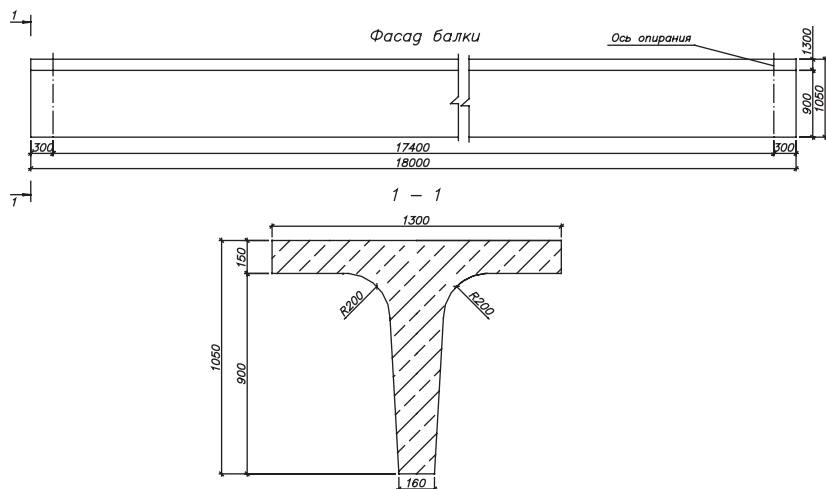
Конструкция полномасштабных железобетонных балок длиной 18 м
